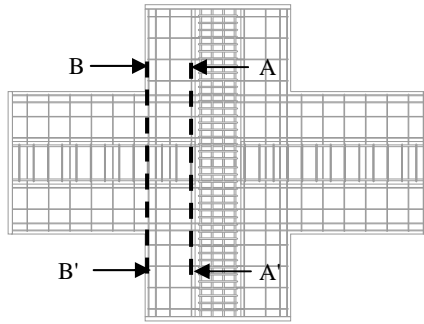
試験体の危険断面位置 (例: SP-J1 試験体)
